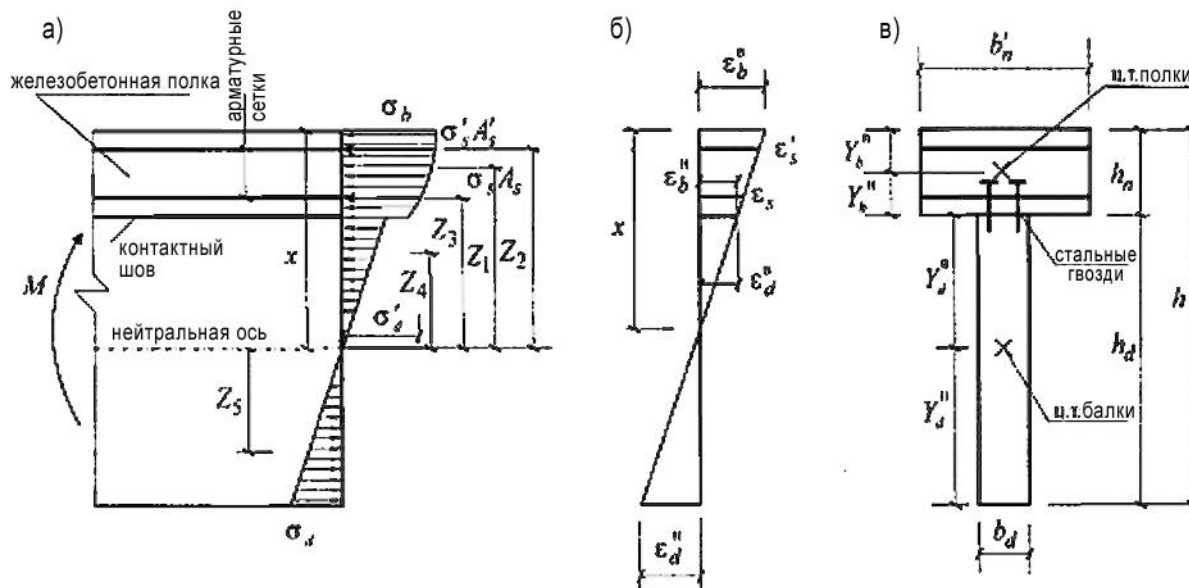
Расчетная схема усилий, эпюры напряжений и деформаций при расчете выносливости нормальных сечений деревожелезобетонных изгибаемых элементов без учета податливости связей сдвига:
